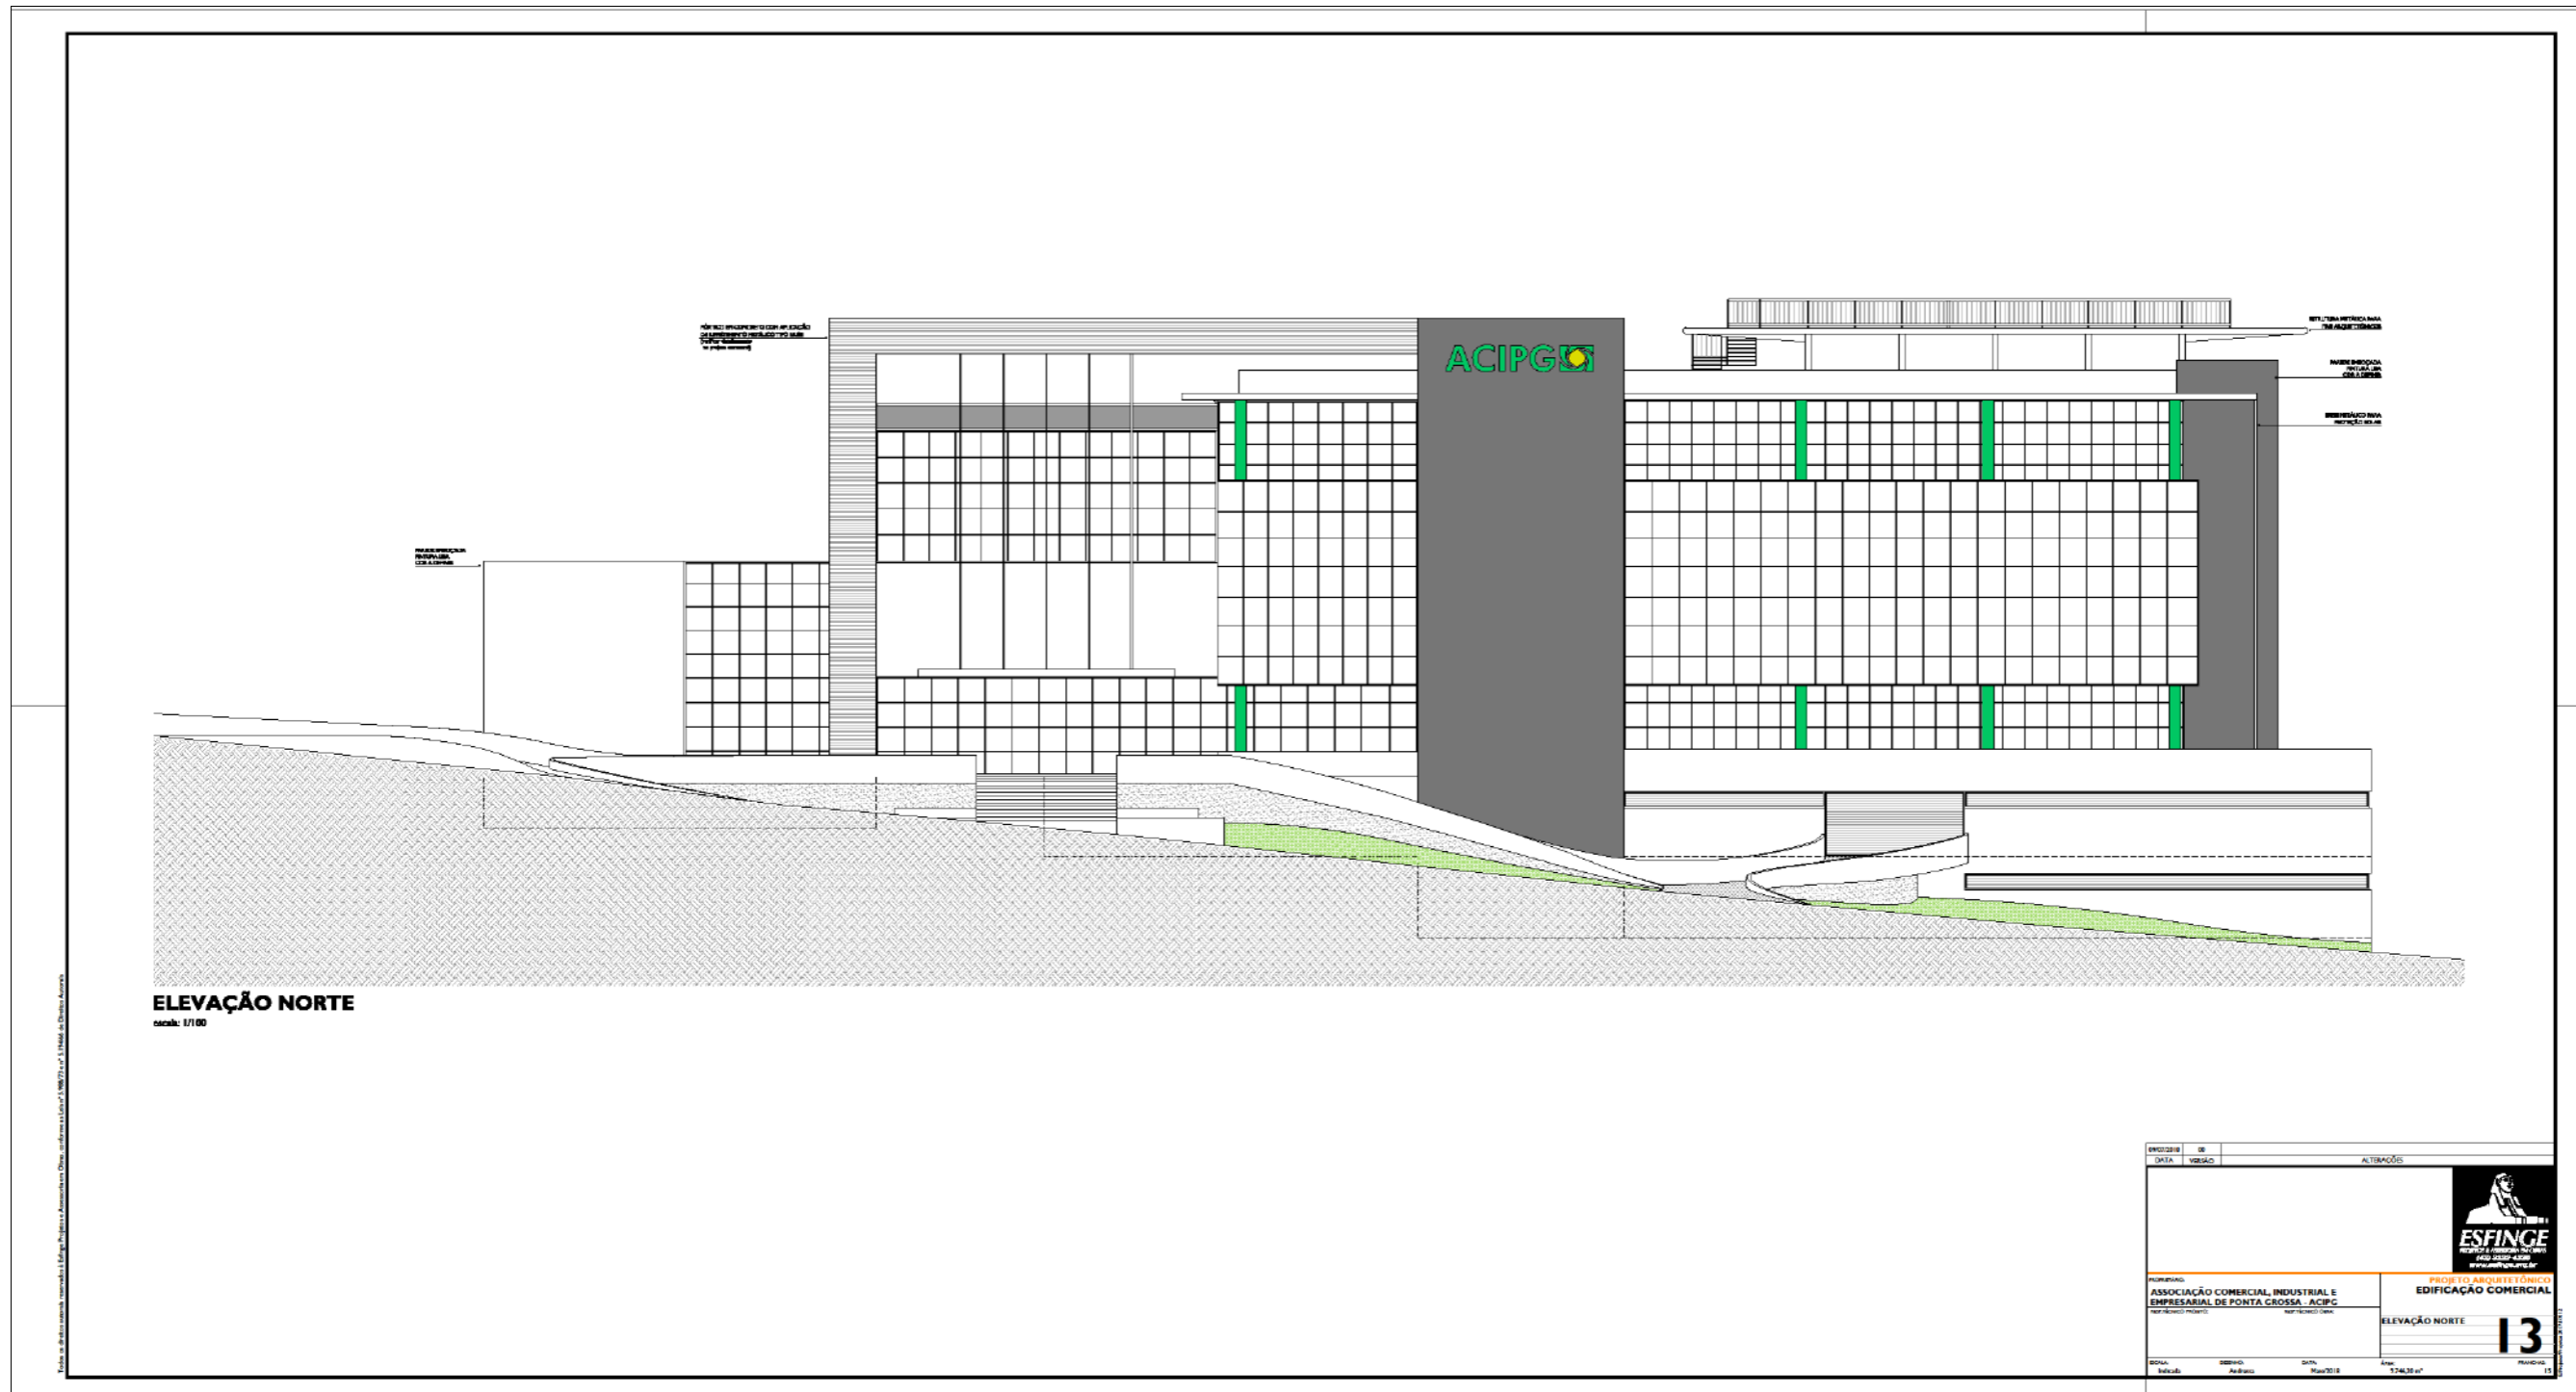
Elevação Norte. Fonte: Esfinge Arquitetura e Engenharia (2018).
